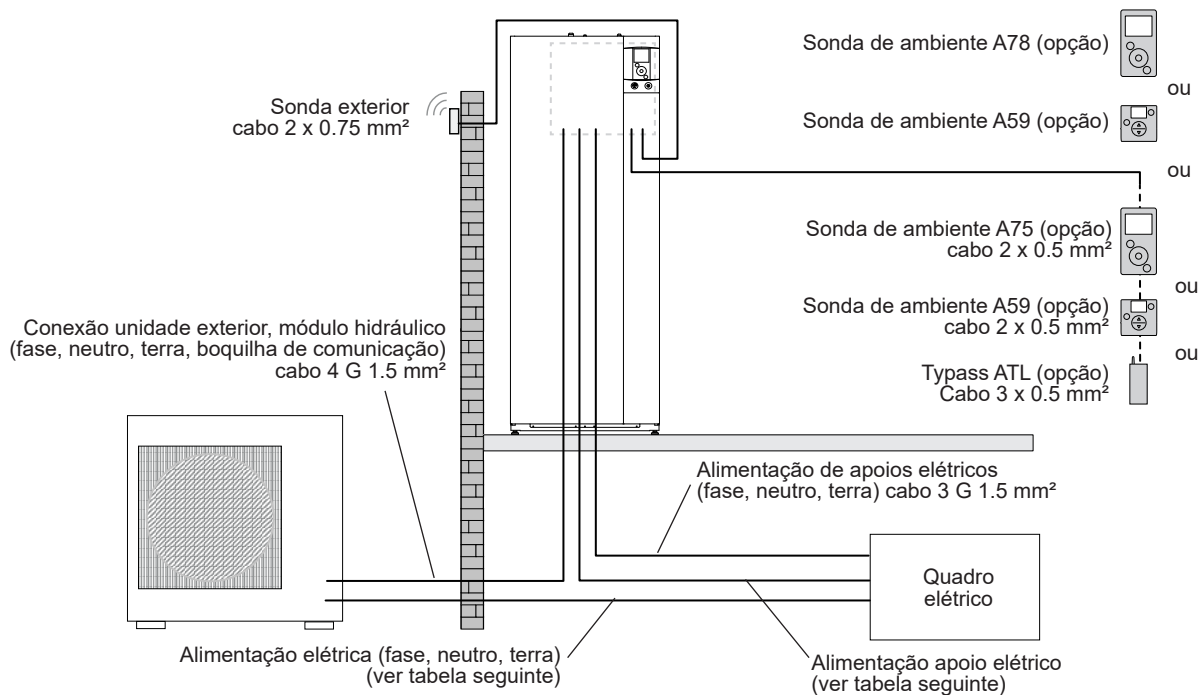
Esquema de conjunto das ligações elétricas para uma instalação simples (1 circuito de aquecimento)
